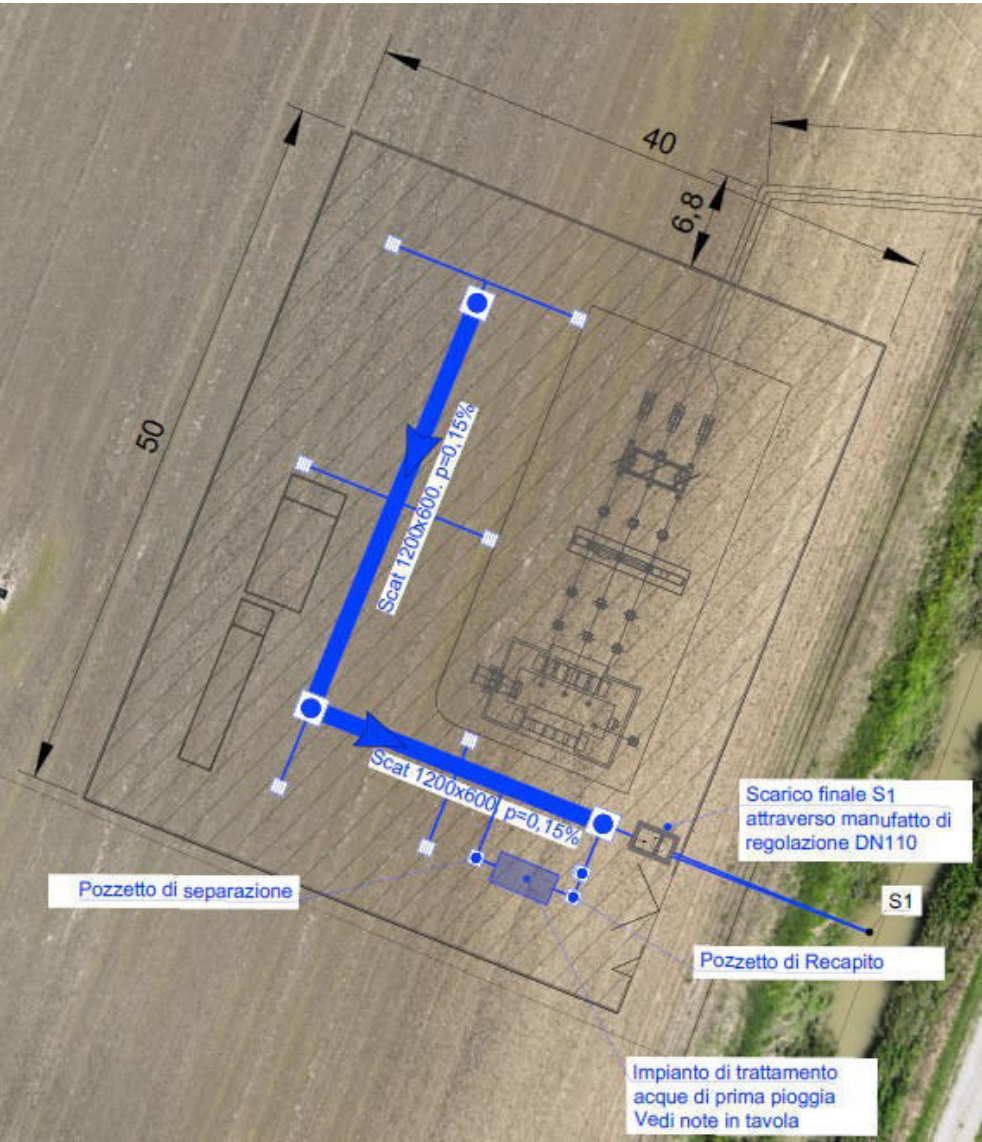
Schema rete acque bianche della Sottostazione di elevazione in progetto (per dettagli si rimanda all’elaborato Cod055_FV_00069_PLANIMETRIA OPERE DI REGIMENTAZIONE DELLE ACQUE SOTTOSTAZIONE ELETTRICA).
